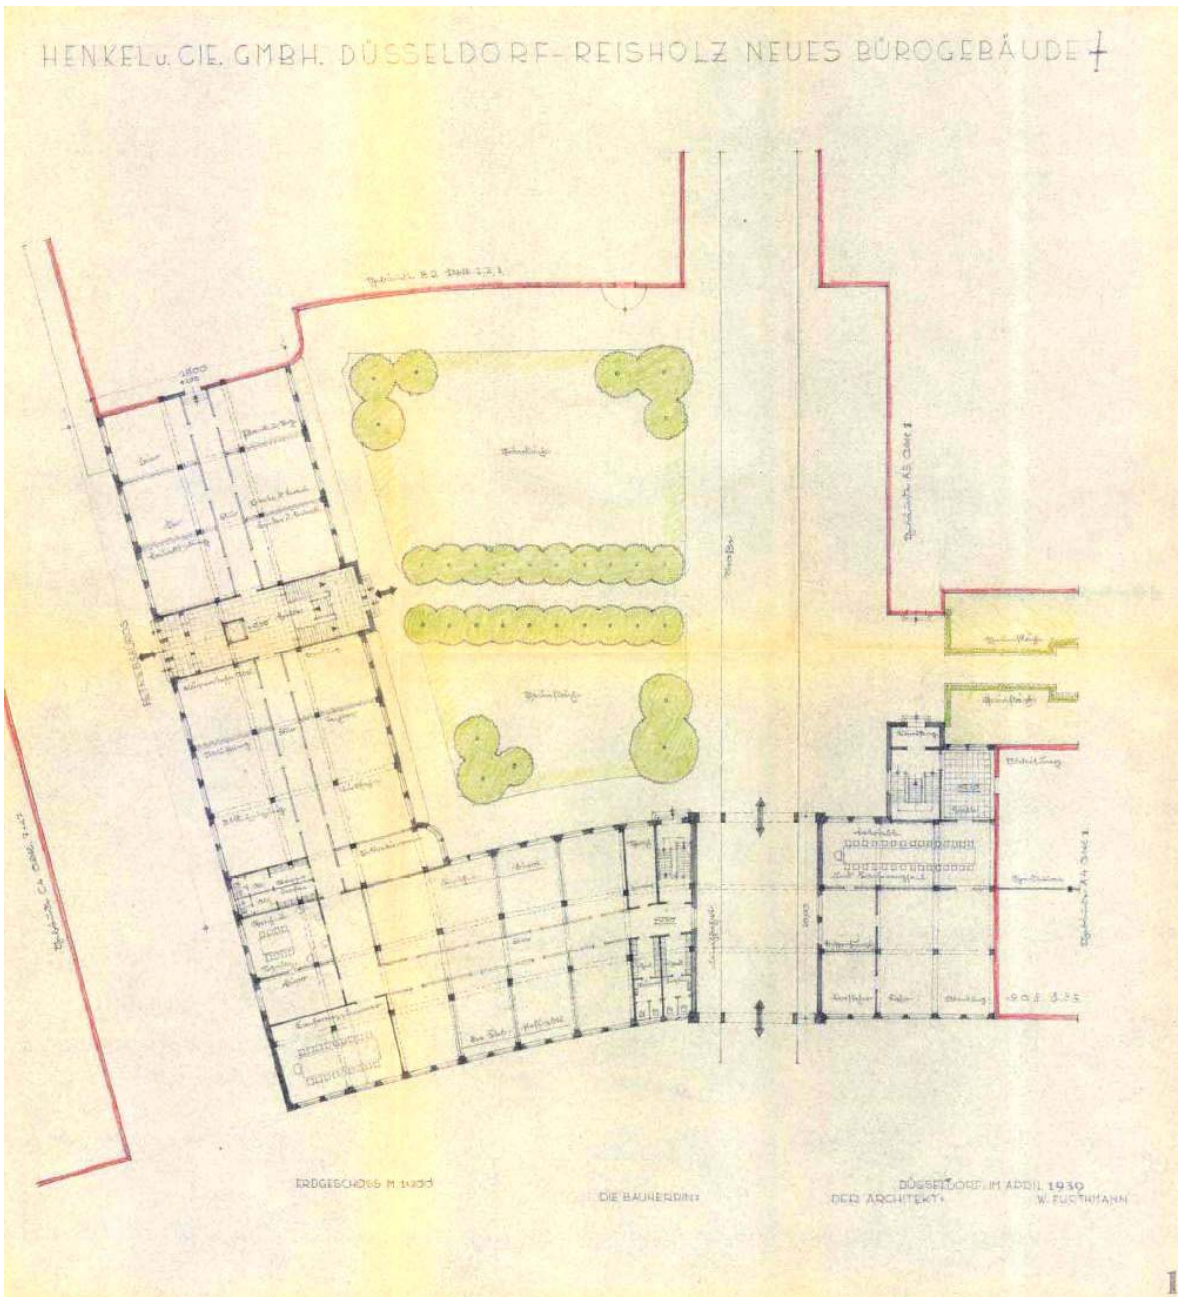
Entwurf zum Bürogebäude, Grundriss-Erdgeschoss, April 1939 – Architekt: W. Furthmann
